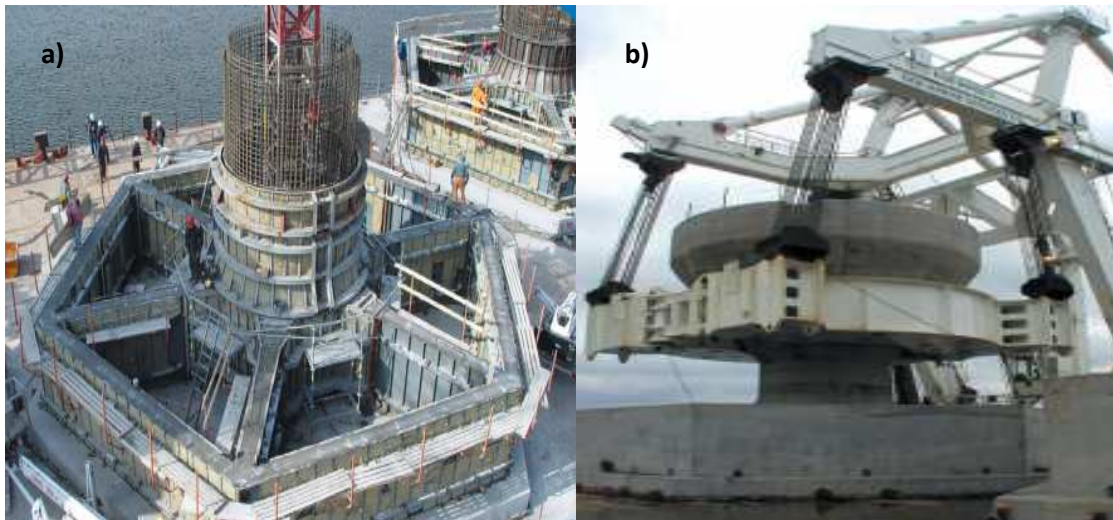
Cimentación por gravedad, a) cimentación con planta hexagonal y módulos exentos de hormigón que facilitan el transporte. b) cimentación con ensanche en cabeza a modo de plataforma de trabajo y protección contra bloques de hielo. [10]
